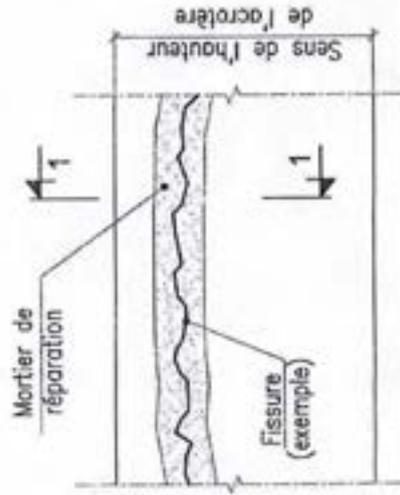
DETAIL DE REPARATION PAR CALFEUTREMENT DES FISSURES
